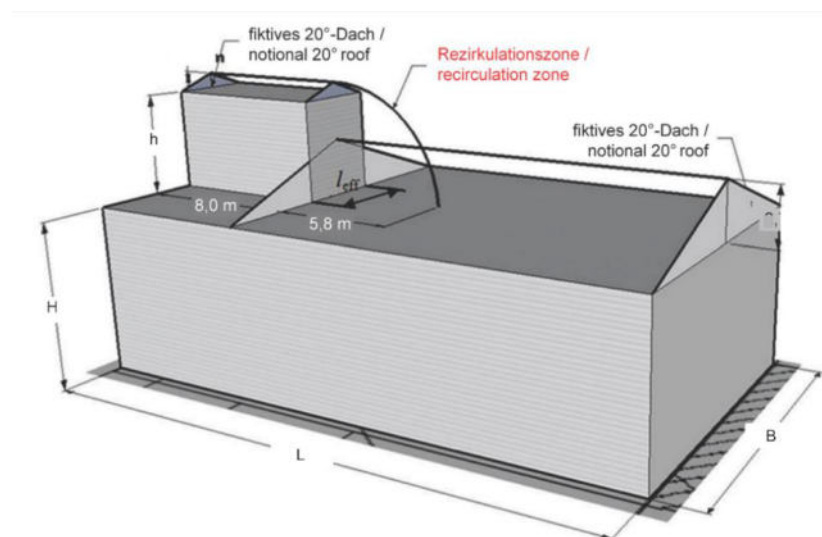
Prinzipskizze zur Ermittlung der Schornsteinhöhe an einem Einzelgebäude mit Dachaufbau. Aus: VDI 3781, Blatt 4.
